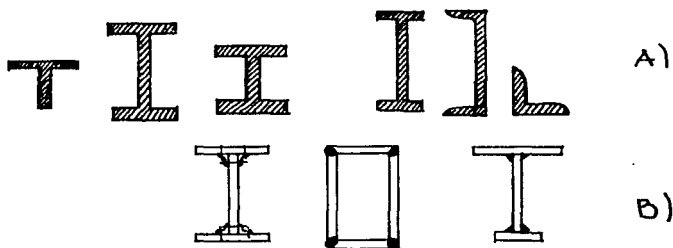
SECCIONES TÍPICAS DE ACERO: A) PERFILES LAMINADOS B) MIEMBROS ARMADOS,
